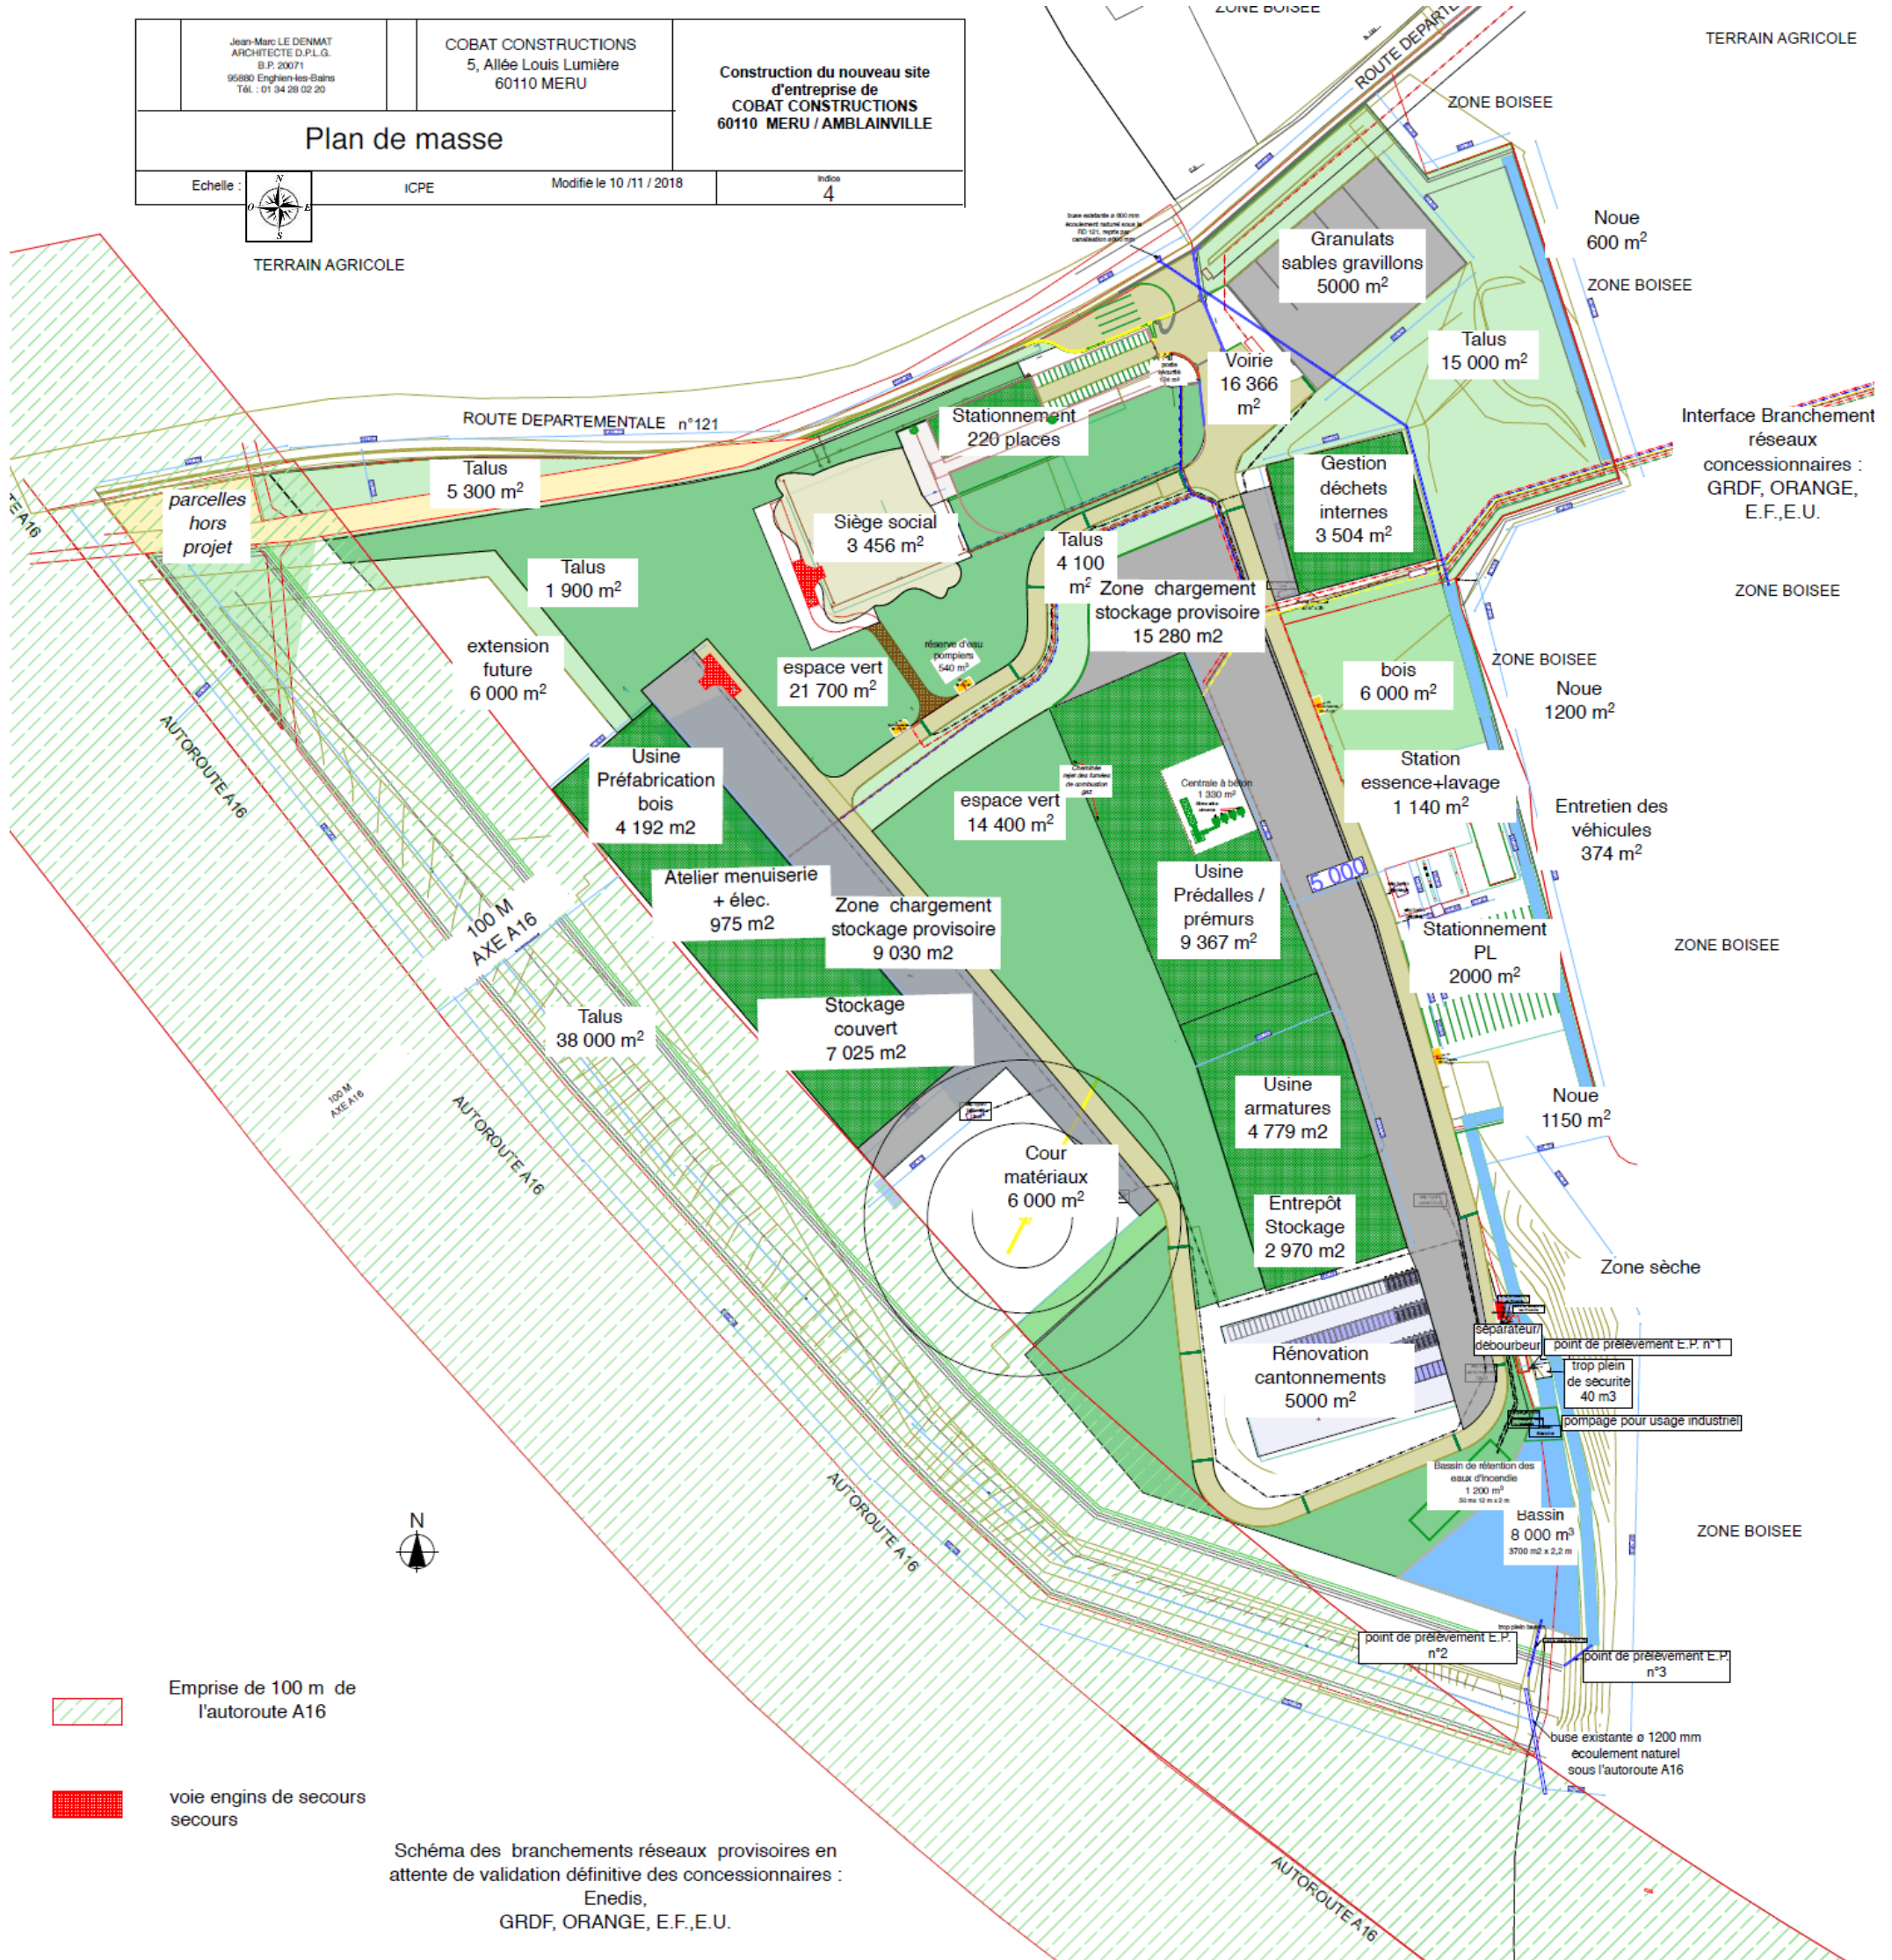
Plan masse du projet (source : JM LE DENMAT, Architecte)
